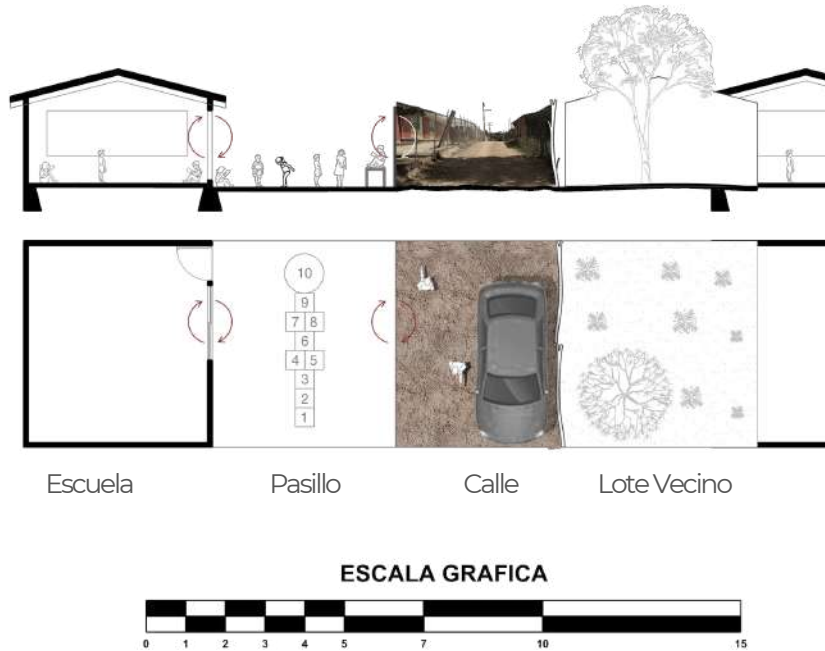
Perfil de calle Corte transversal y planta de calle de La Escuela Ejercito Mexicano
